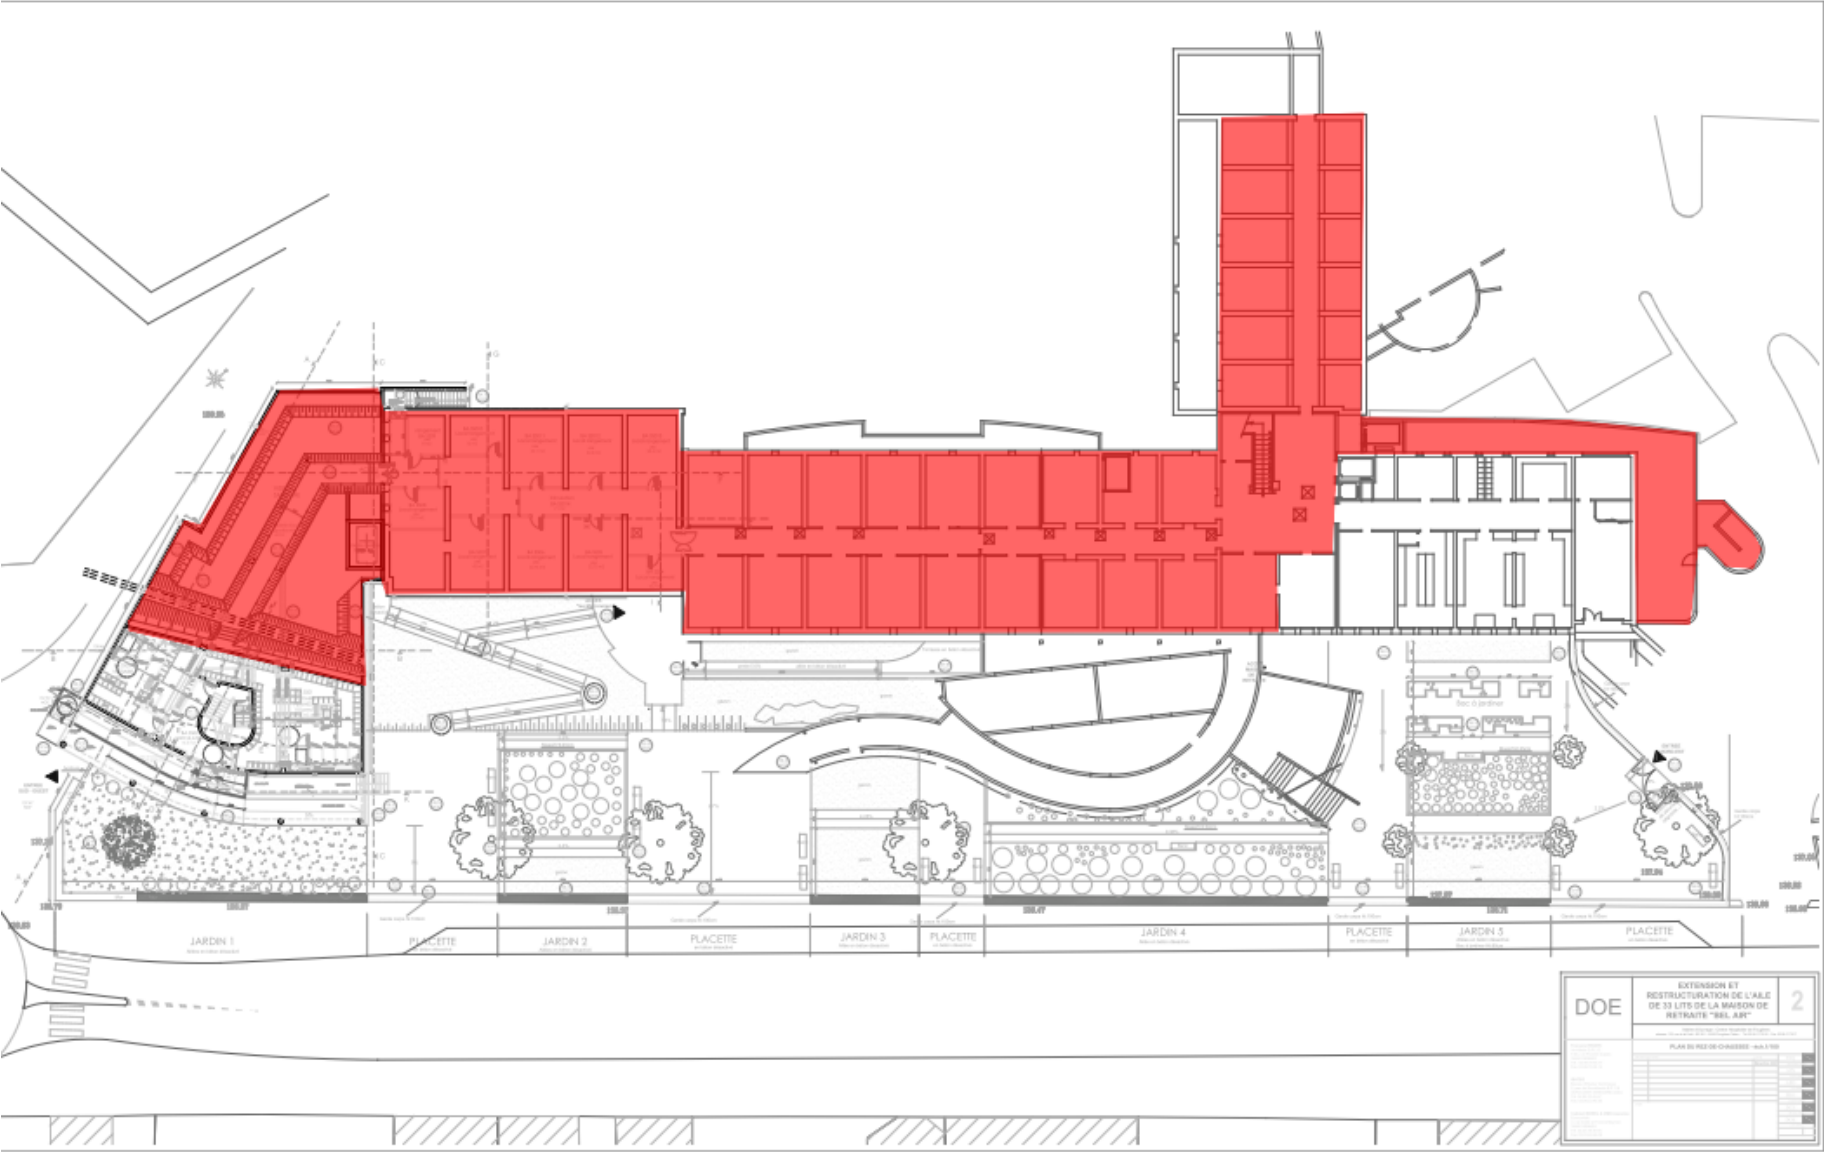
Plan de repérage des travaux d'isolation des planchers vers LNC de Bel Air
